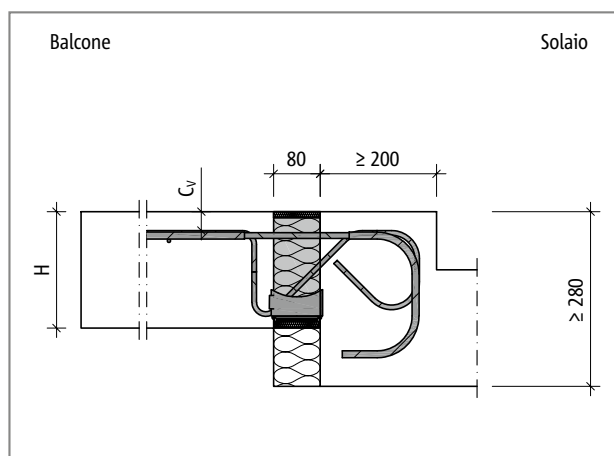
Schöck Isokorb® T tipo KL-O-M8 - KL-O-M12: balcone con innalzamento e isolamento esterno
